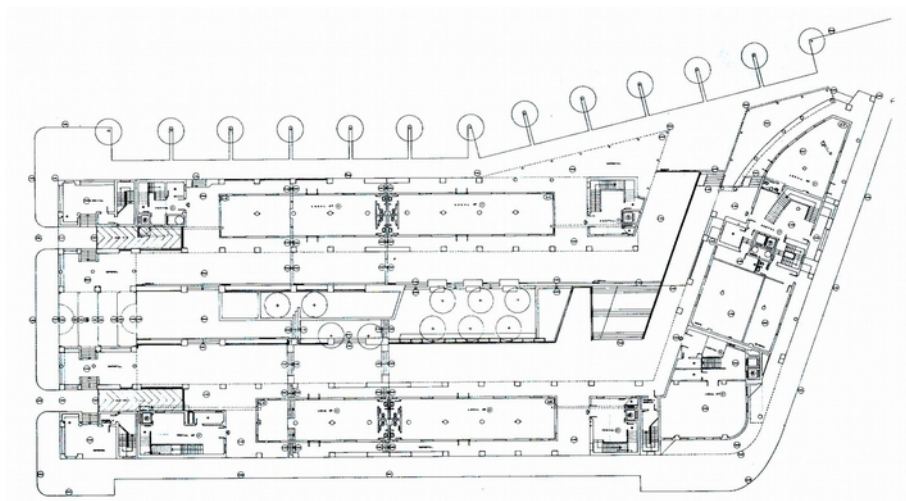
Planta baja del inmueble de Orcasitas, con el patio, los núcleos de acceso y los locales comerciales. Fuente: Calle (1993)
